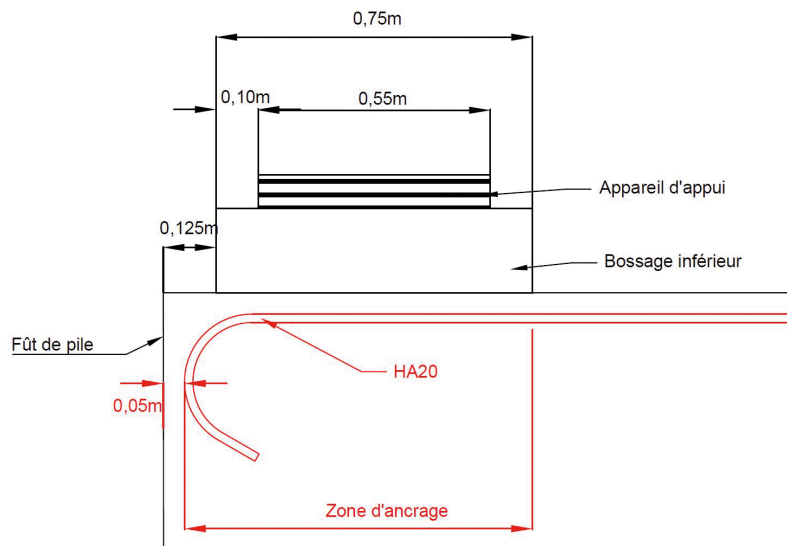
Zone d'ancrage pour bossage de faible hauteur
